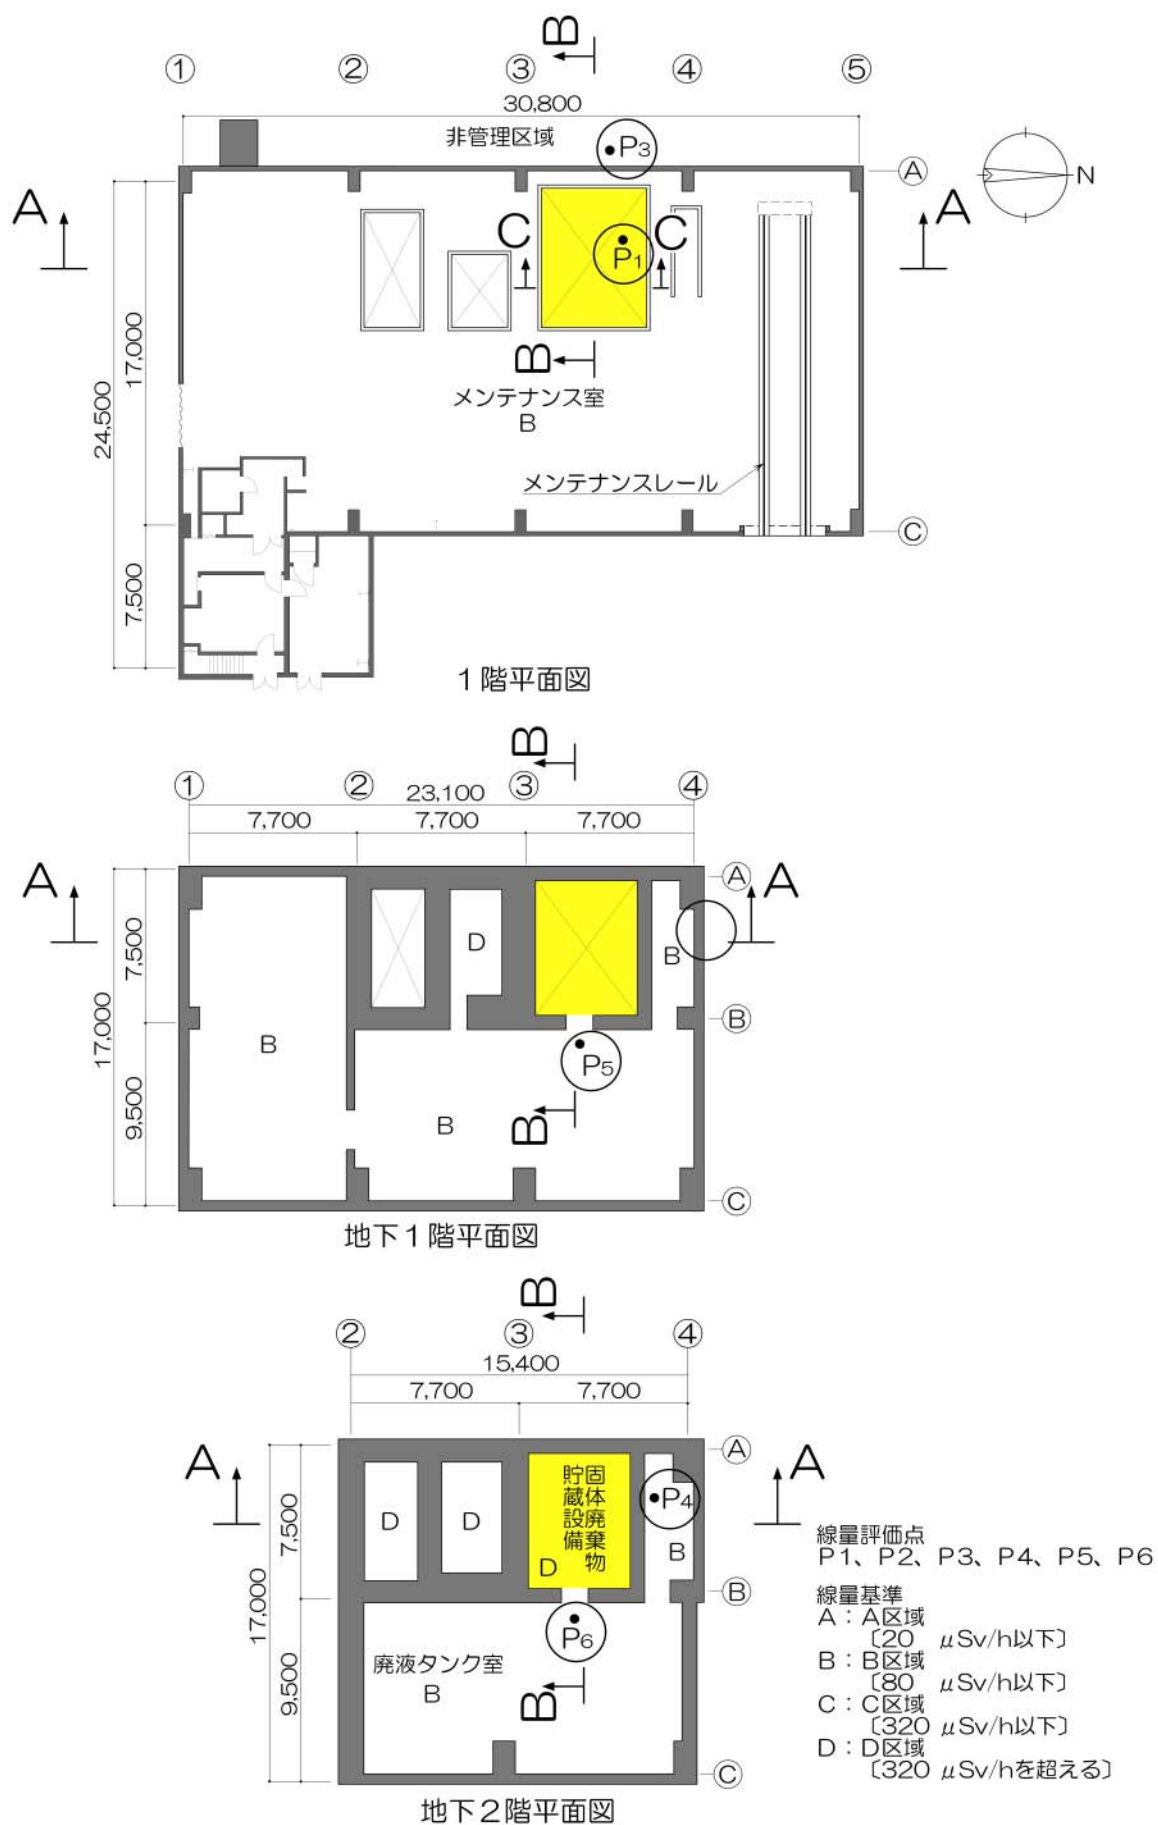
(1/2) メンテナンス建物の配置図 (平面図)
